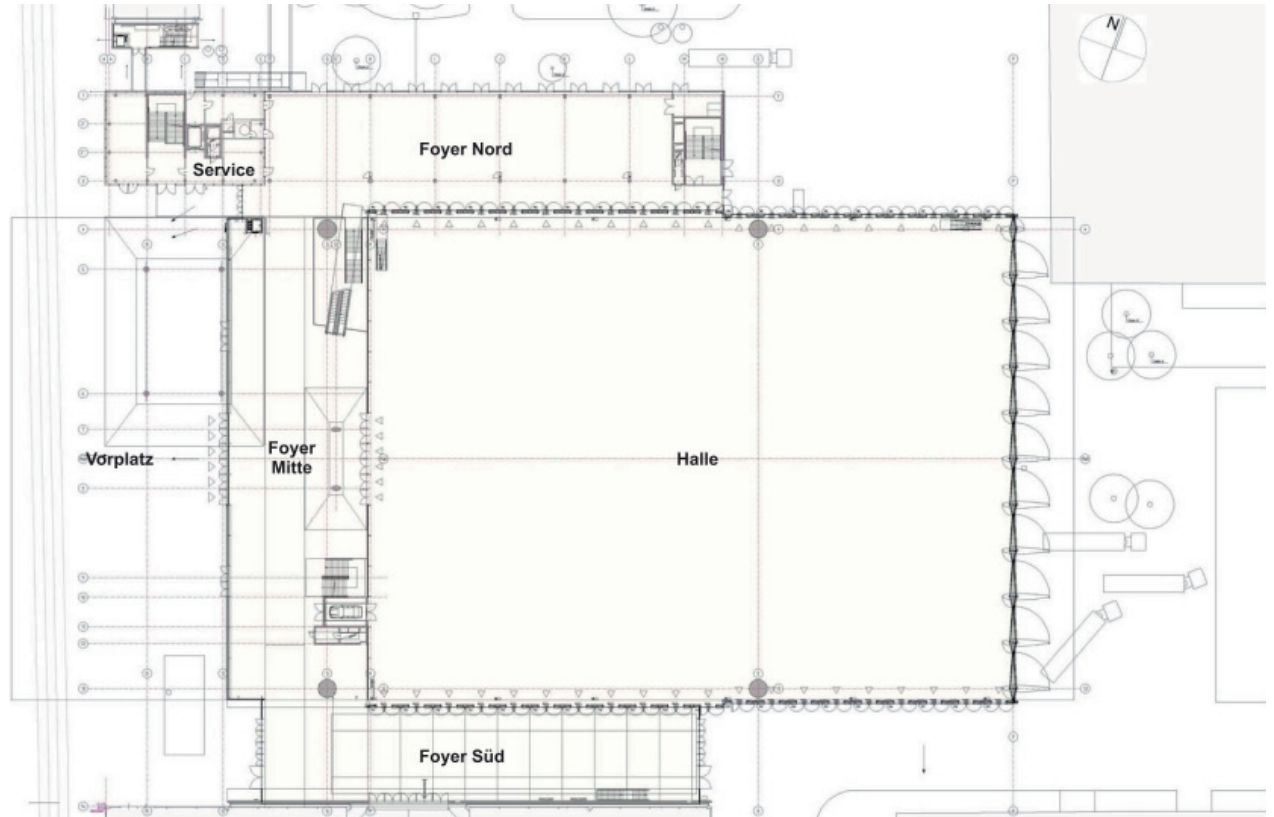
Stadthalle Graz, Grundriss Erdgeschoß, o.M.
